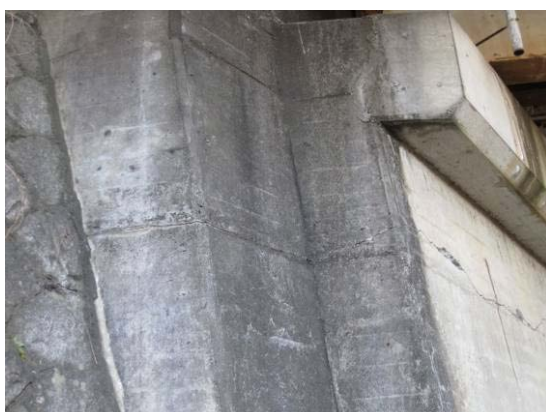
A 1 橋台右側面のひび割れ
